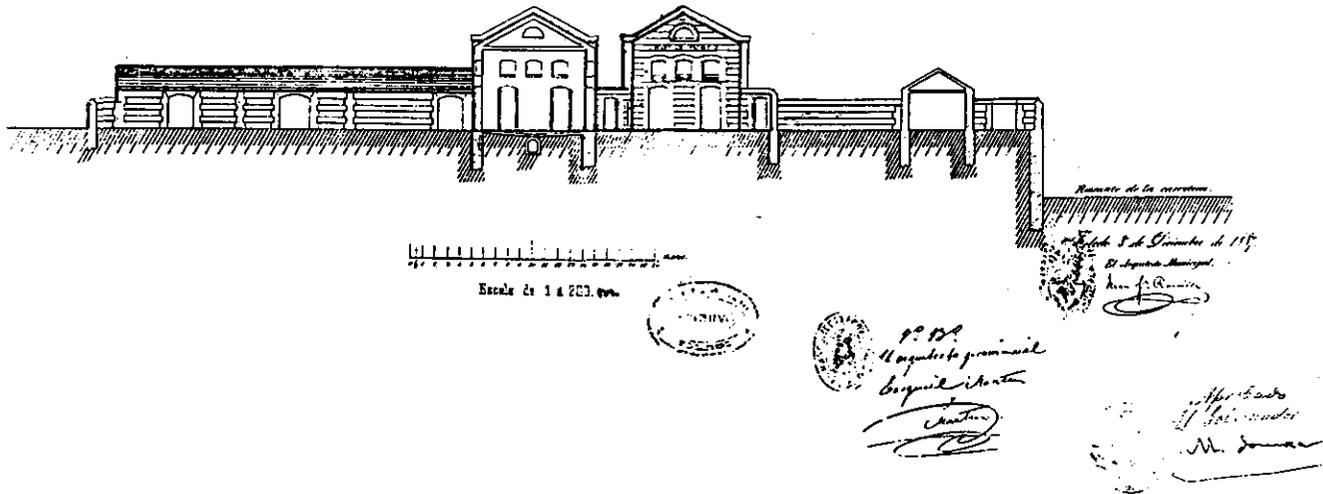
Alzados del Matadero según el proyecto de 1887 de García Ramírez. (A.M.T.)
